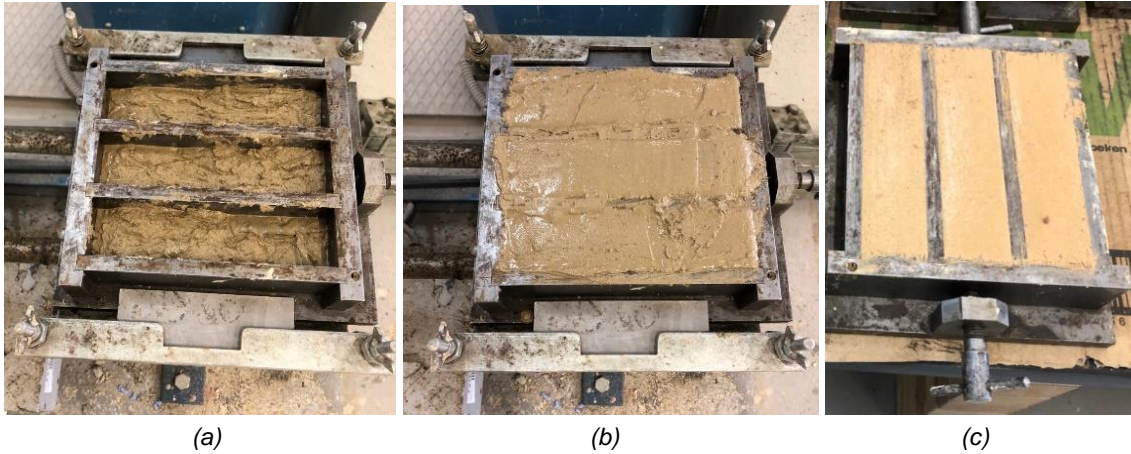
Etapas do processo de moldagem: (a) preenchimento de 50% do molde, (b) preenchimento do restante do molde e (c) rasamento do molde
